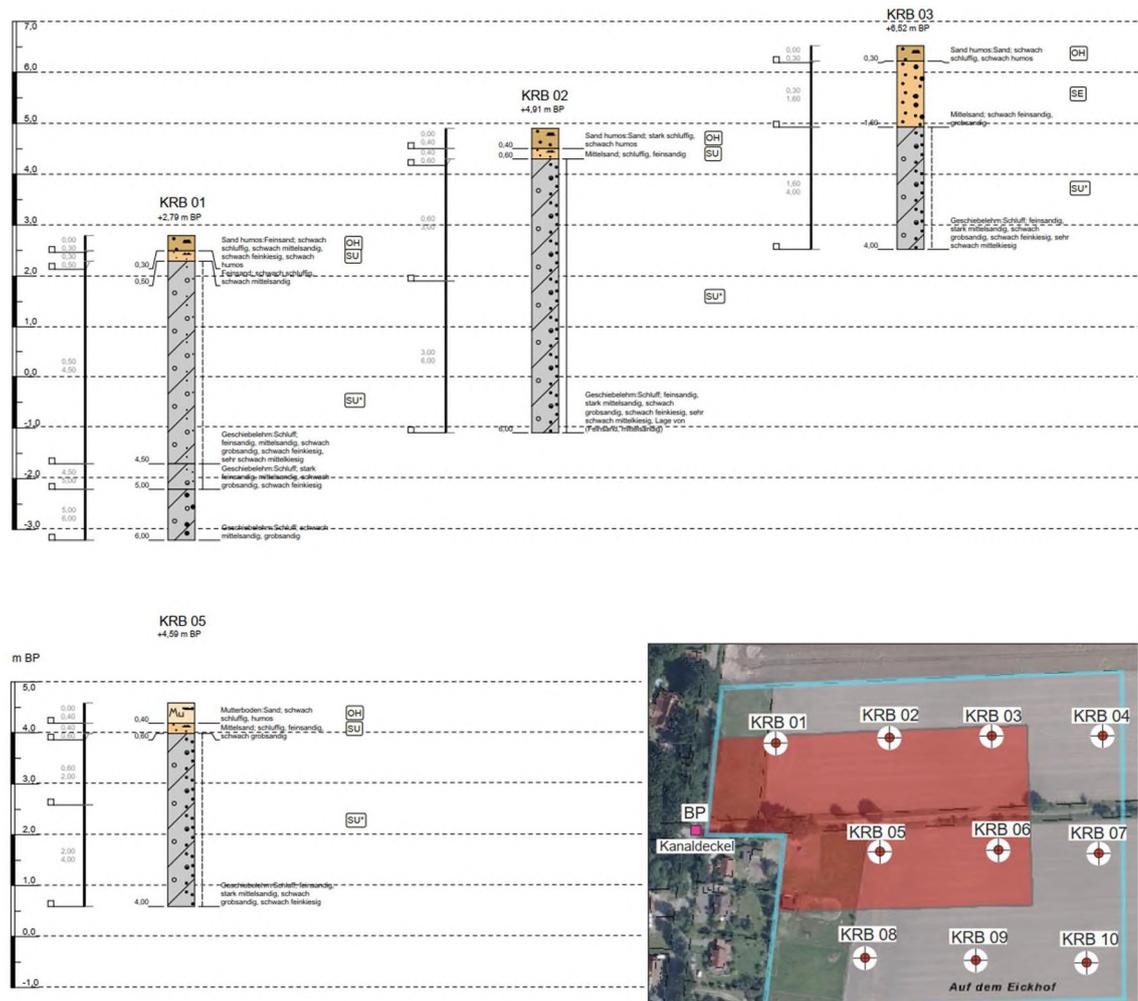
Auszug aus Baugrundgutachten: bindige Böden im Plangebiet
